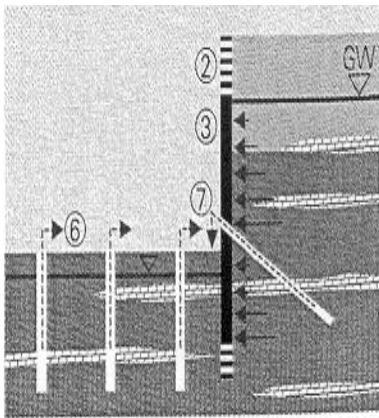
Teildichte Baugrube, Wand- und Sohleinspannung
